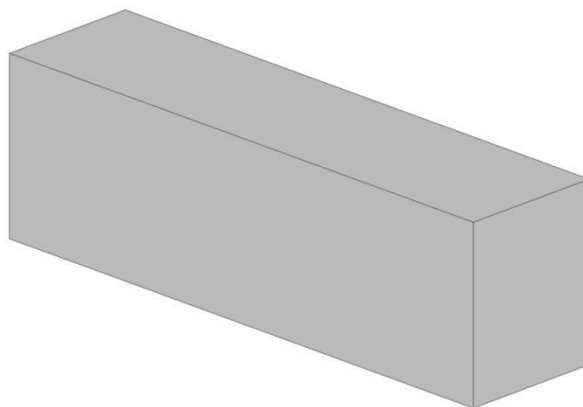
Vista em três dimensões de uma Viga (A ou B)
